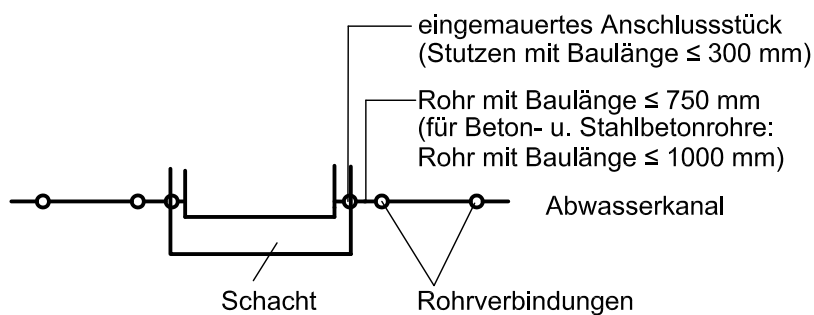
Einsteigschacht DN 1000 mit Schachtunterteil aus Mauerwerk nach DIN 4034-10 und Regelblatt 100 – dargestellt: Abwasserkanal DN 600
